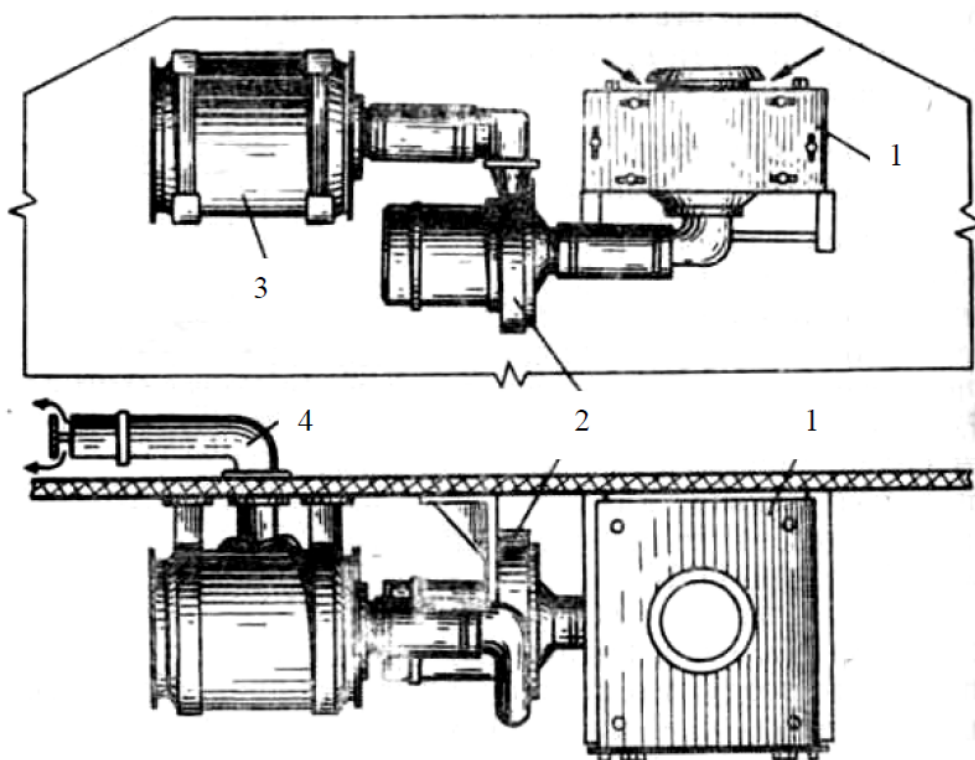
Фильтровентиляционная установка ФВУА-100:
